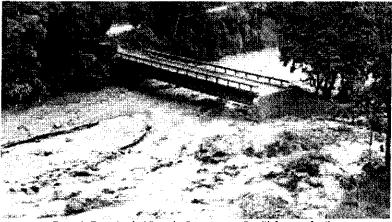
Puente de Viga de Concreto – Perfil Aguas Arriba
